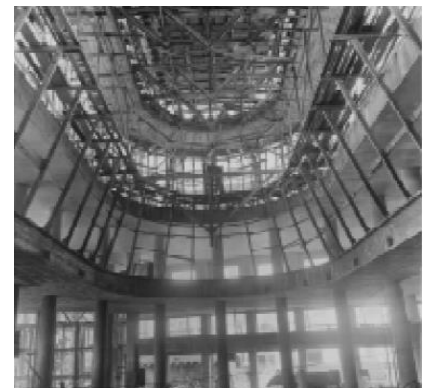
Construção da fachada do Magazine Mesbla com destaque para secagem das estruturas em concreto e ancoragem com madeira pinus(s.d.). Fonte: Canez (2006).
